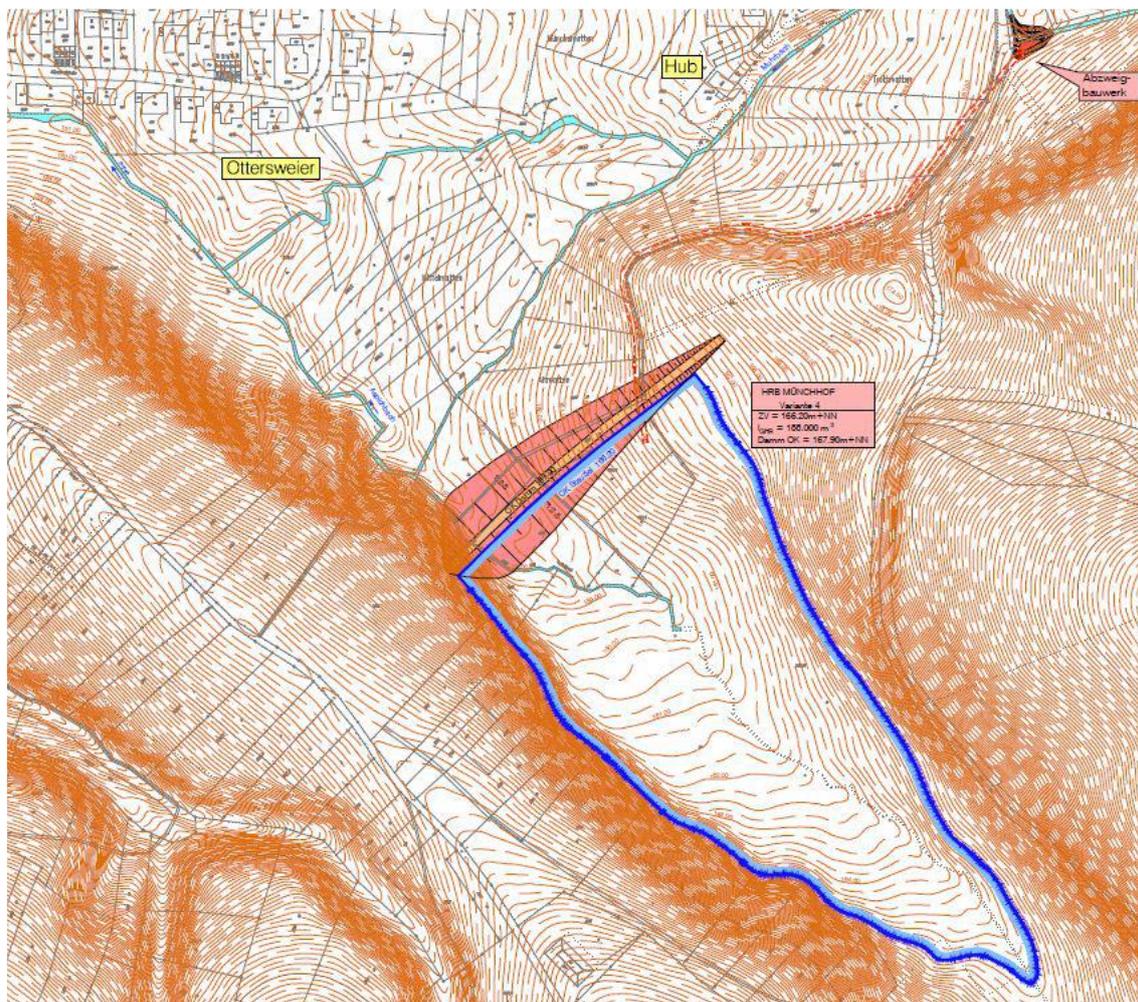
Plan für Dammbauwerk mit Staubereich, Variante 4 (ZINK Ingenieure, Stand Juli 2013).
